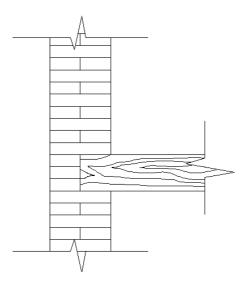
Encuentro viga de madera con muro, caravista. Fuente: Edición propia
